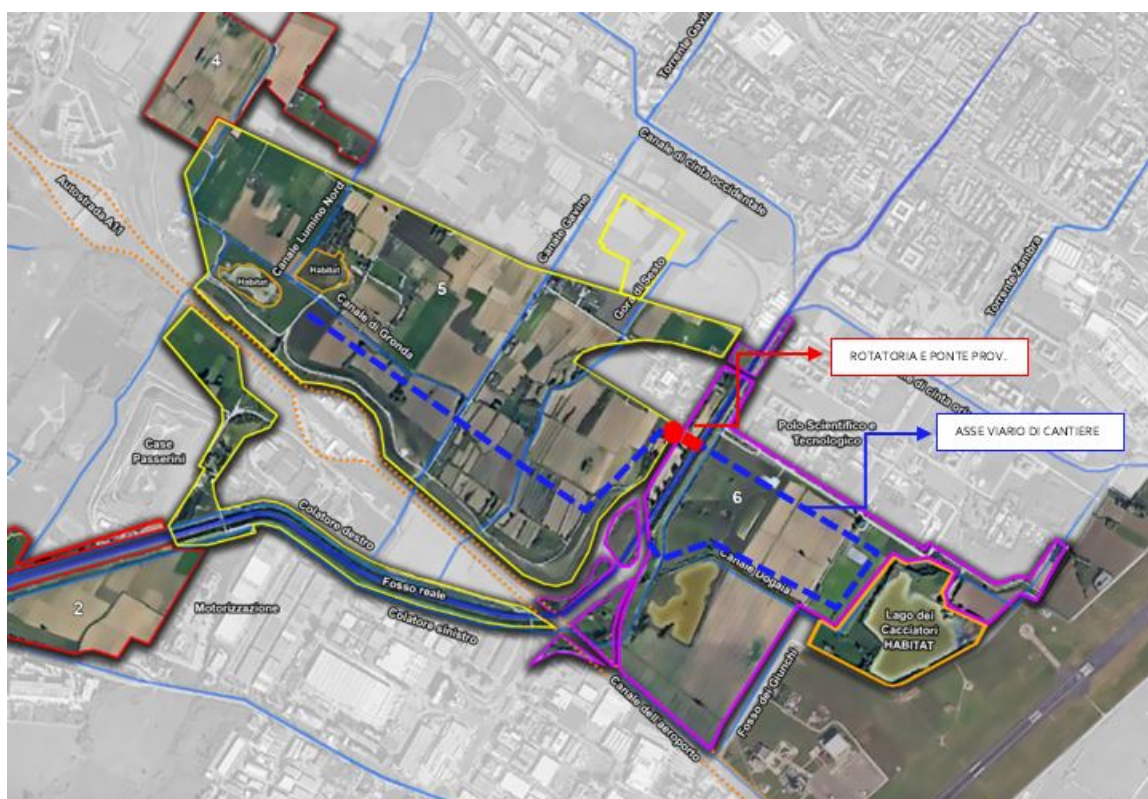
Planimetria di cantierizzazione: viabilità di cantiere
